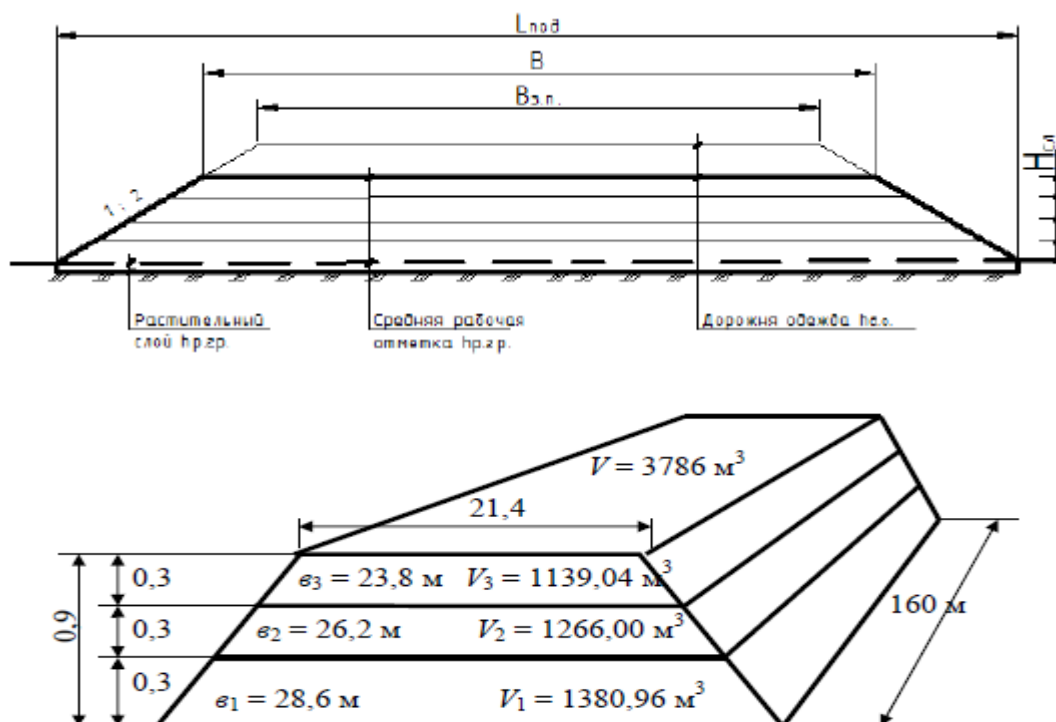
Расчетная схема к определению послойных объемов земляных работ
